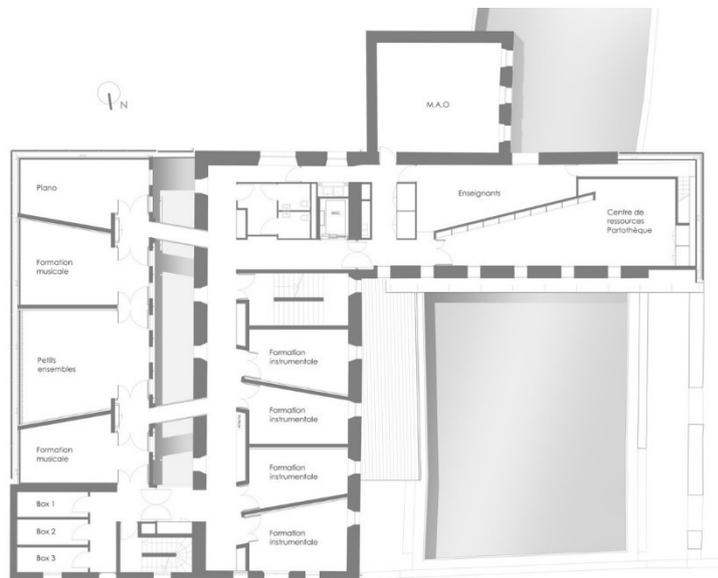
Planta Baixa 1º pavimento. Fonte: Archdaily, 2013.
